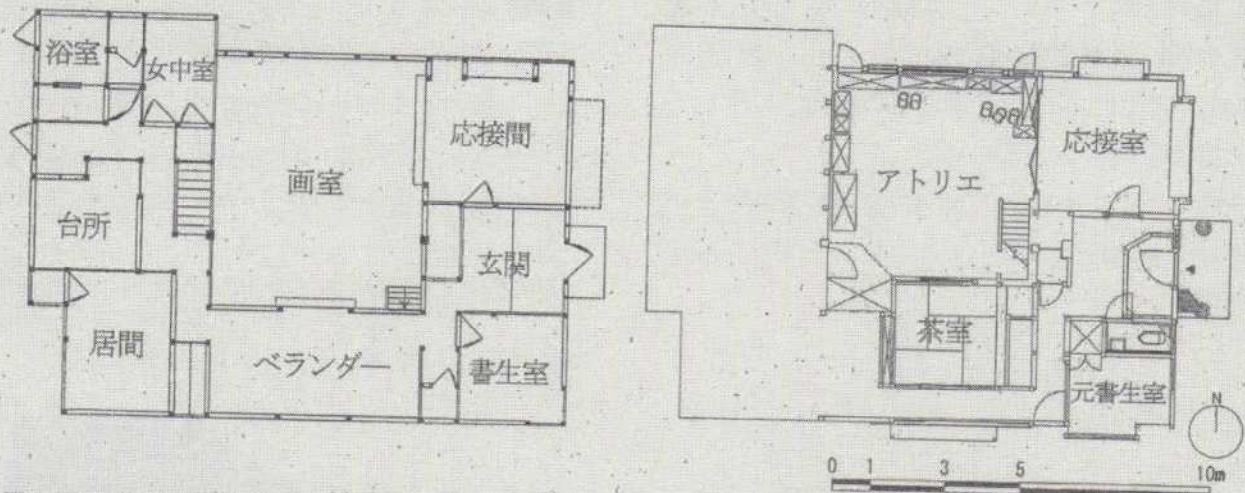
主屋1階平面図 (左:青焼図面 右:現状平面) 1/200
